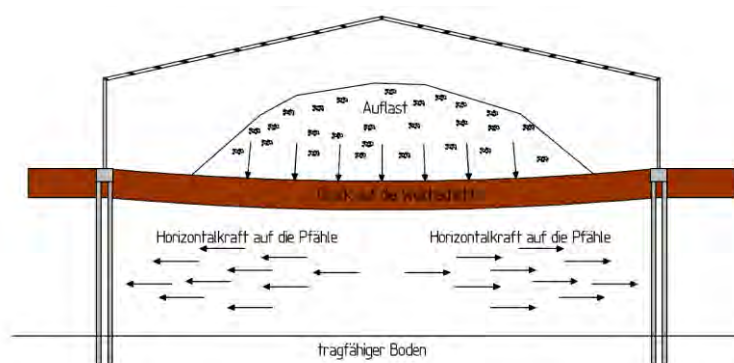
Pfahlgegründetes Hallenbauwerk mit flachgegründeter Sohlplatte
